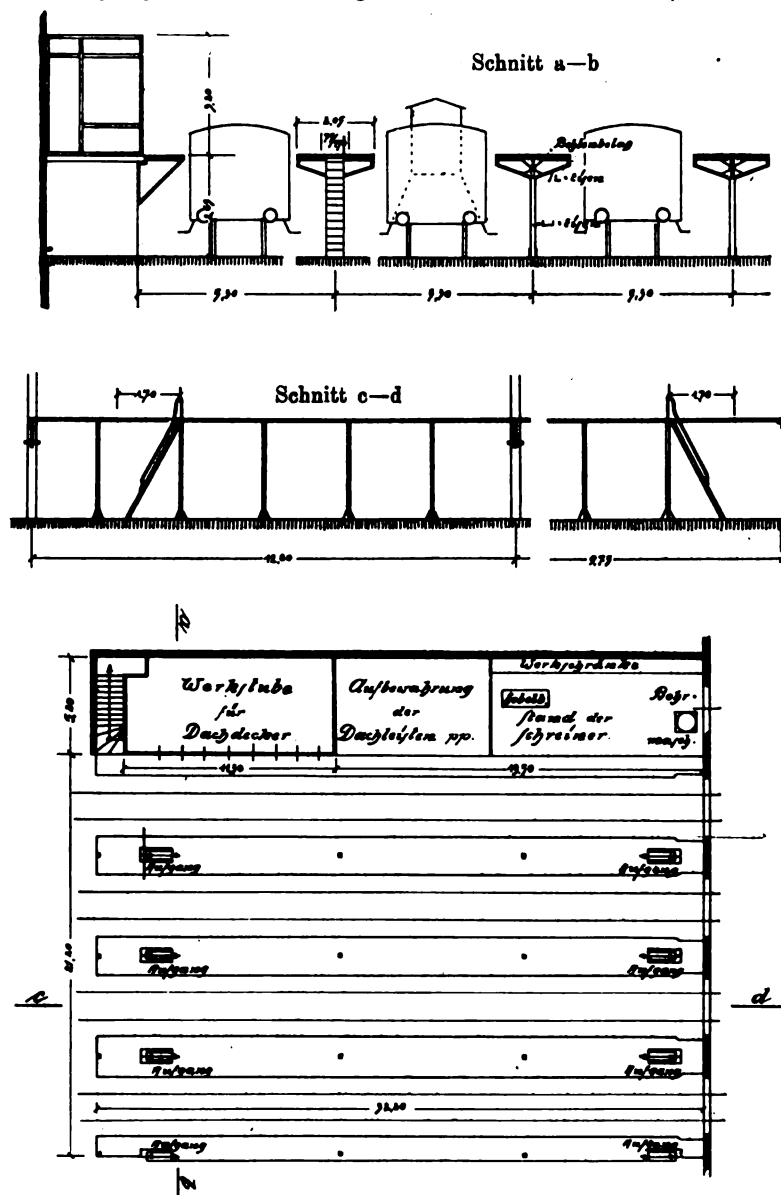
Grundriß und Querschnitte der Dachausbesserungswerkstätte.
